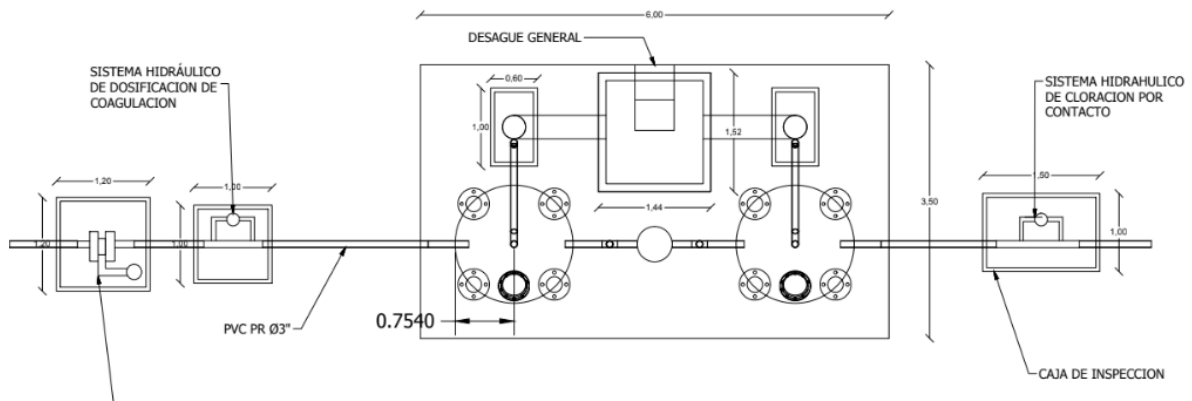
Detalle de componentes de la planta potabilizadora TECNIFLOC
